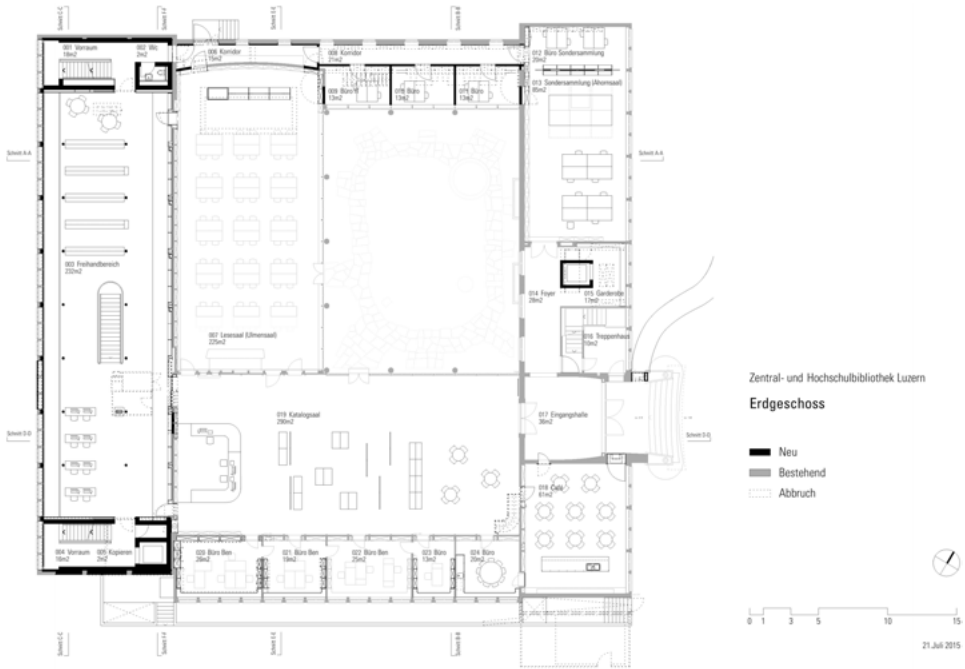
Grundriss neues Erdgeschoss ZHB (© ARGE Lussi+Halter, Luzern)
